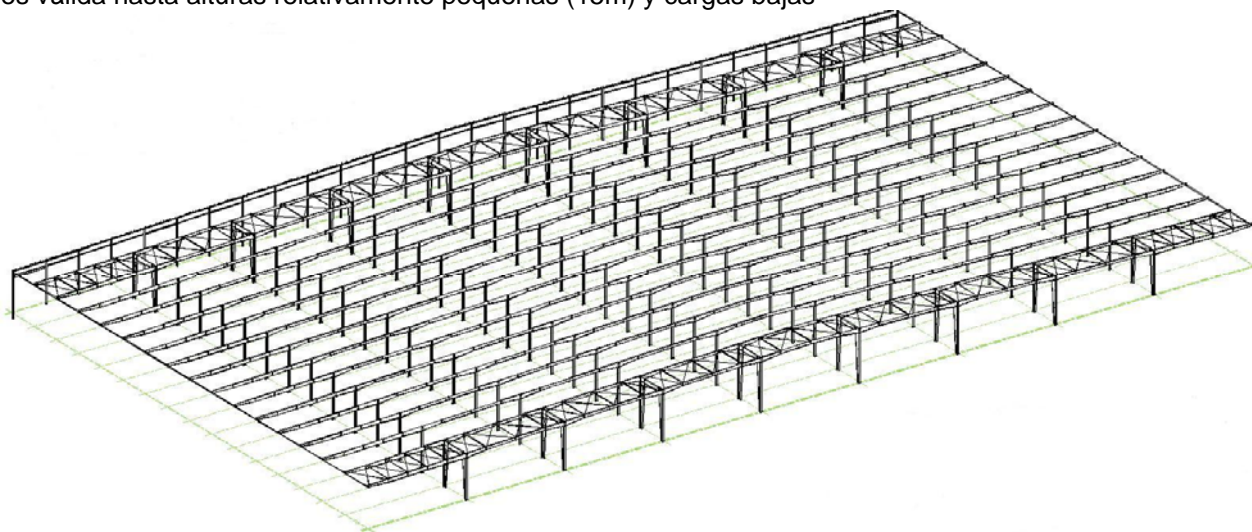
SISTEMA ESTRUCTURAL DE PORTICO ARMADO/LAMINADO Y CERRAMIENTO DE FACHADA AUTOPORTANTE
